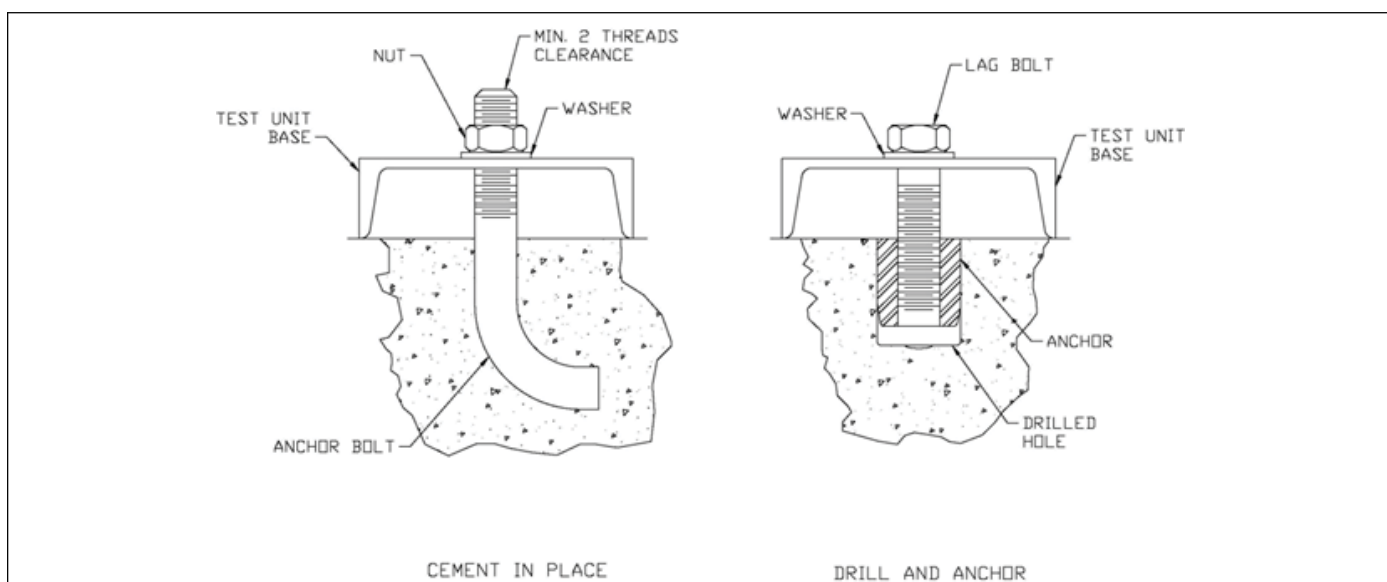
FIXATION DU BANC D'ESSAI
